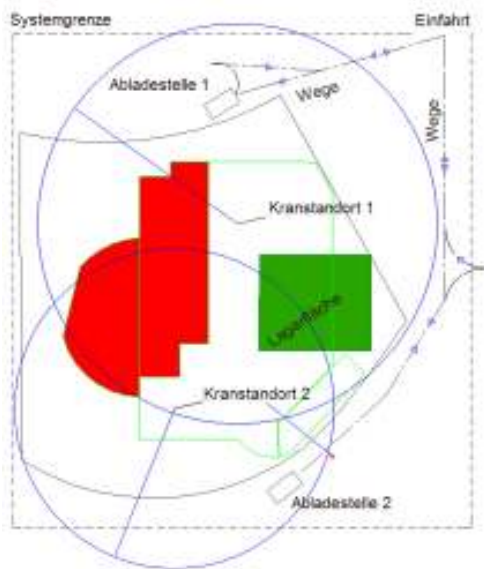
Grundriss Baustelleneinrichtung
